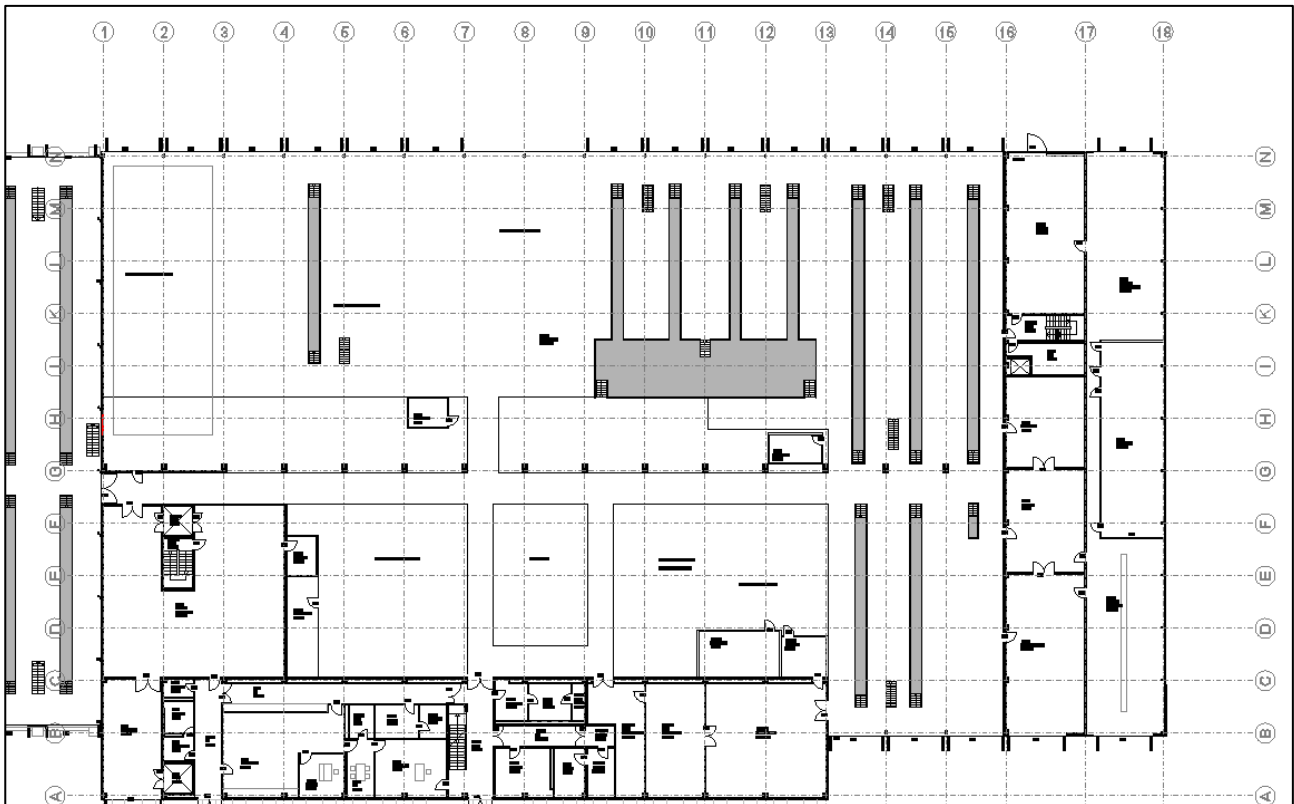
Grundriss Bauteil A4 (Neue Werkstatt), EG
